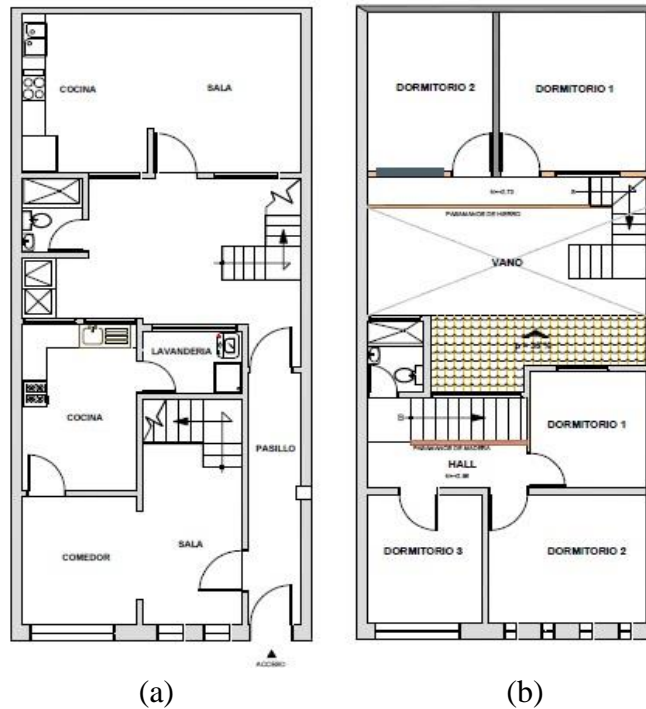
Vistas en planta de la vivienda pequeña: (a) planta baja y (b) planta alta.
